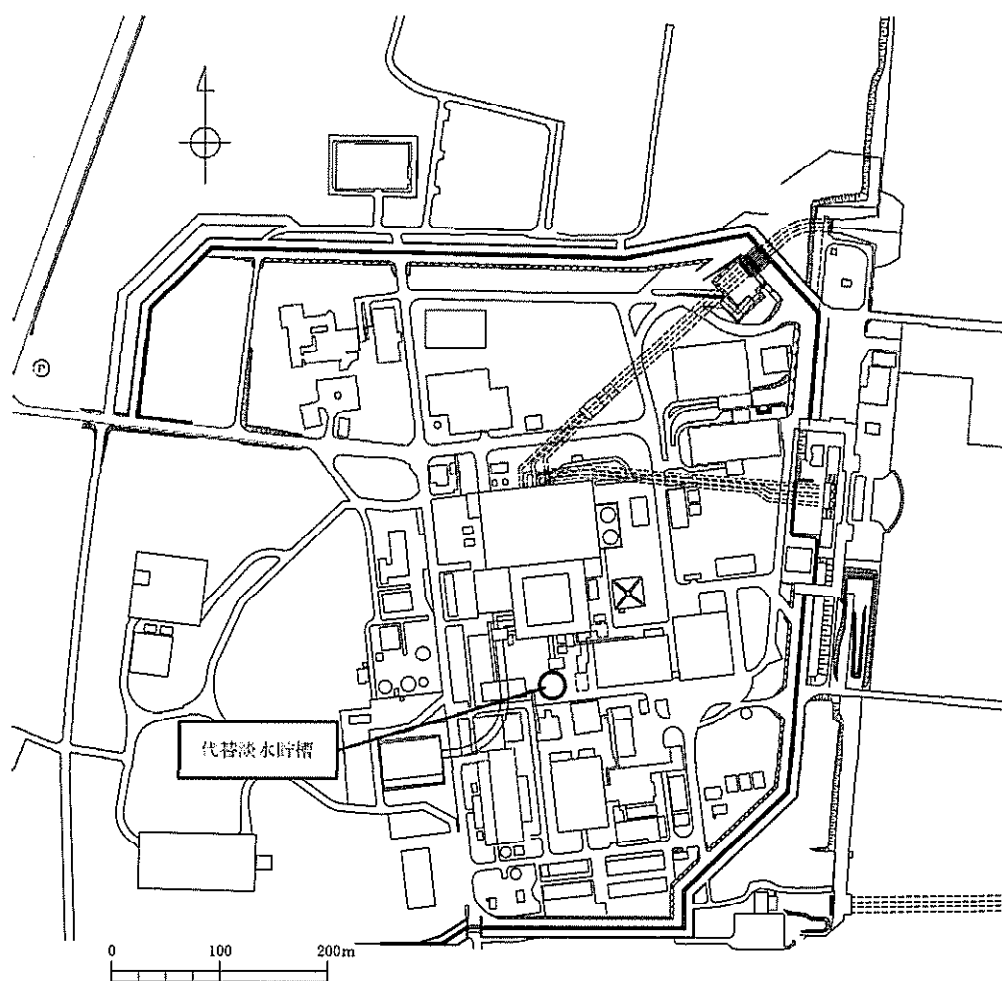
(1) 代替淡水貯槽 平面配置図 (全体平面図)
